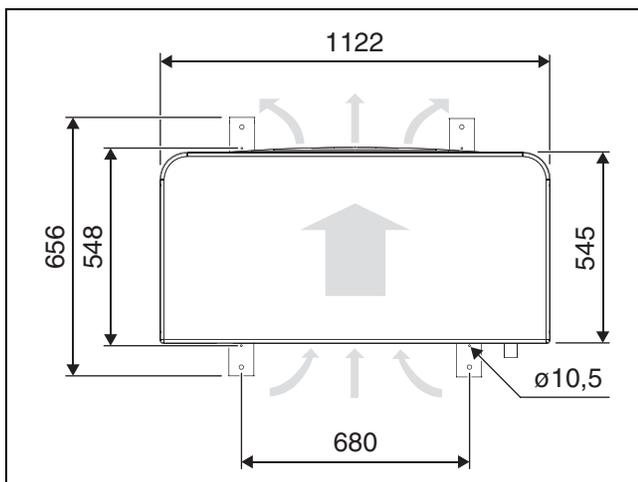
Dimensions des modèles de pompe à chaleur 13-17, vue du dessus
